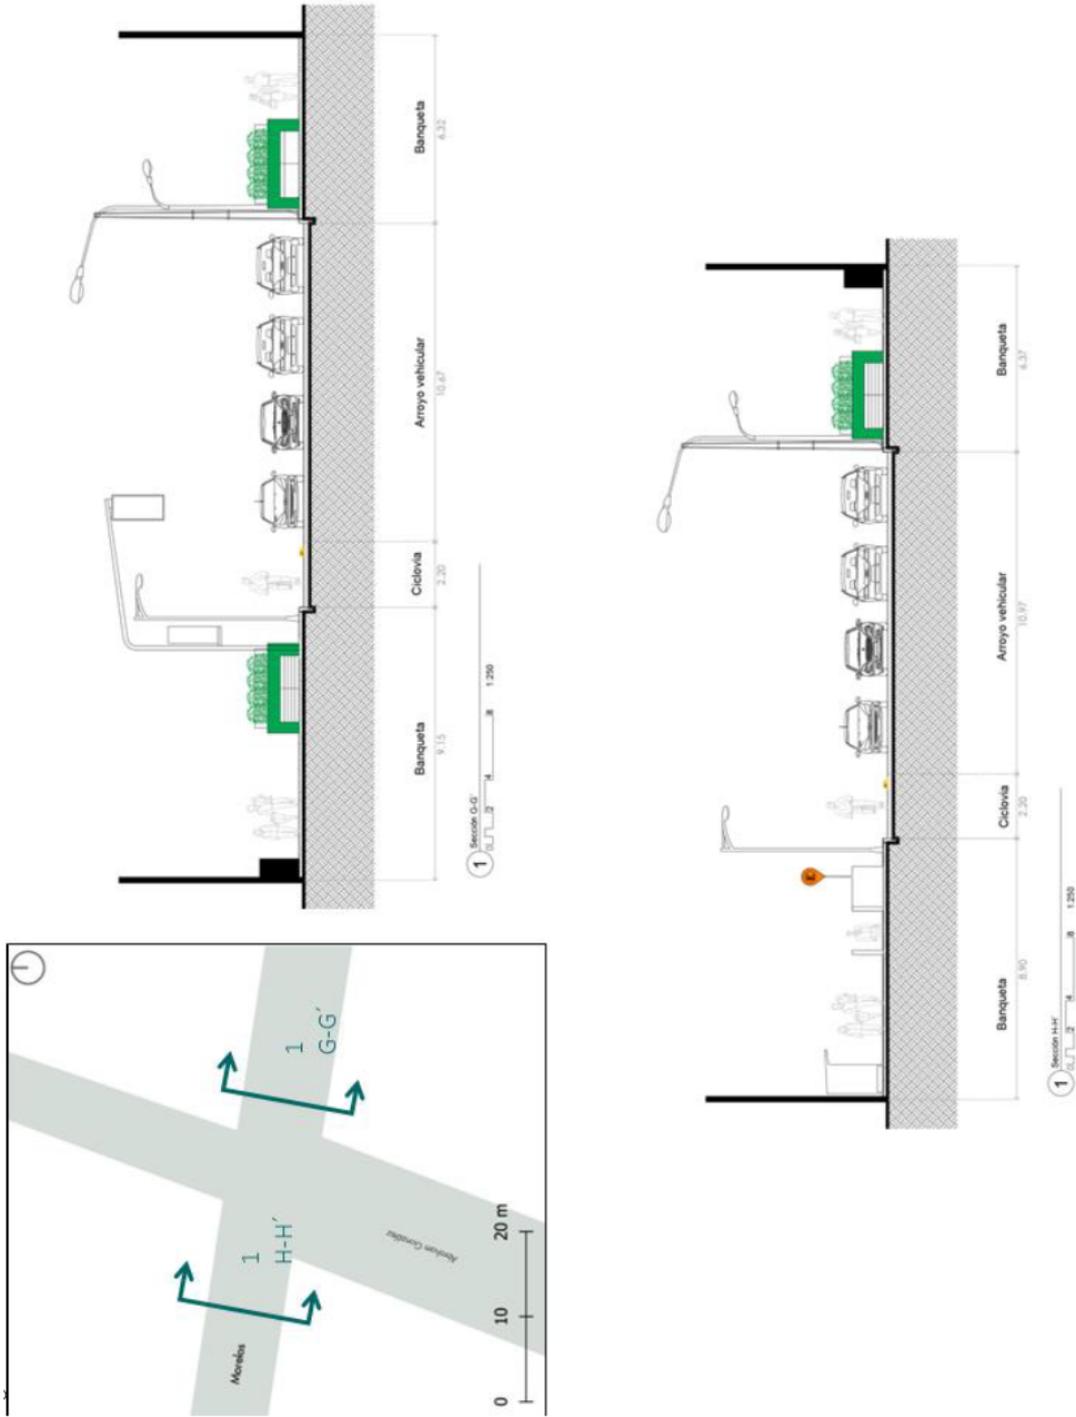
Secciones transversales G-G' y H-H'. Fuente TEUP
